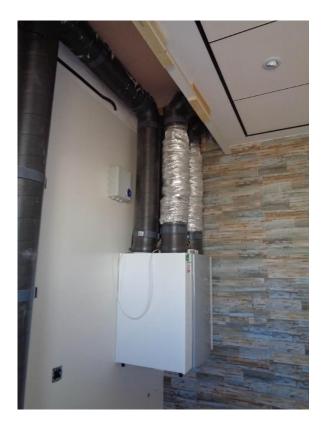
y 55: Recuperador de calor instalado en el lavadero de la vivienda con bypass.
